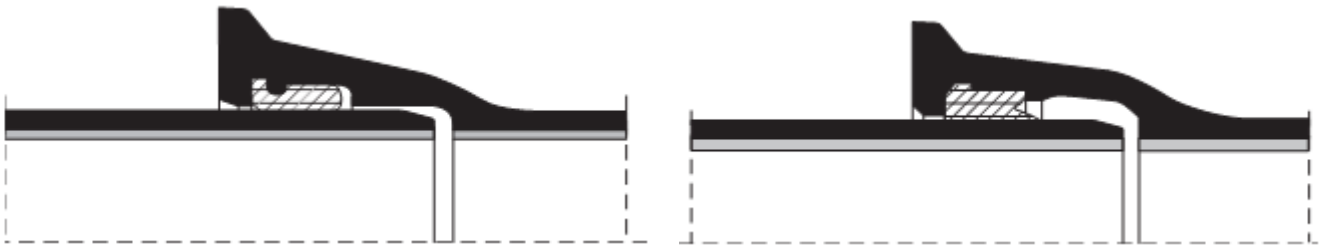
Joint d'étanchéité pour Conduite en acier.
